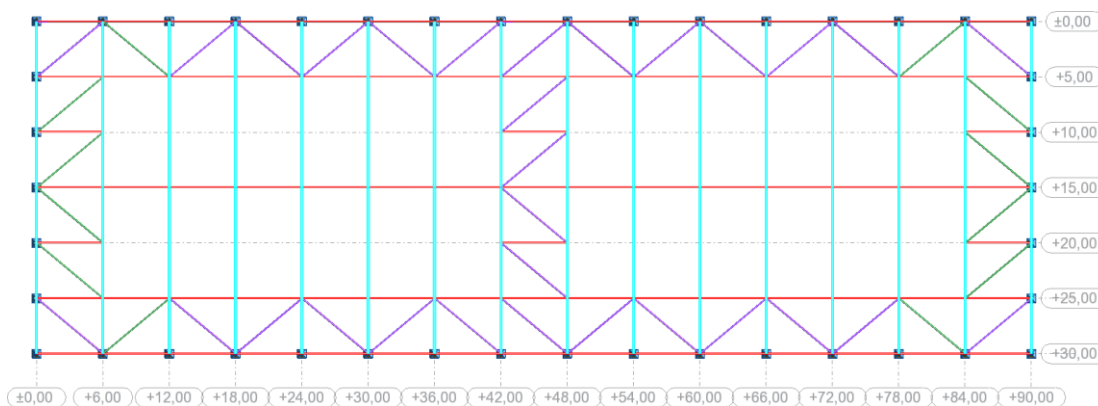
Exemplo da diferença de perfis aplicados no contraventamento em *portal frames* - vista em planta (caso de estudo PF30-6)
